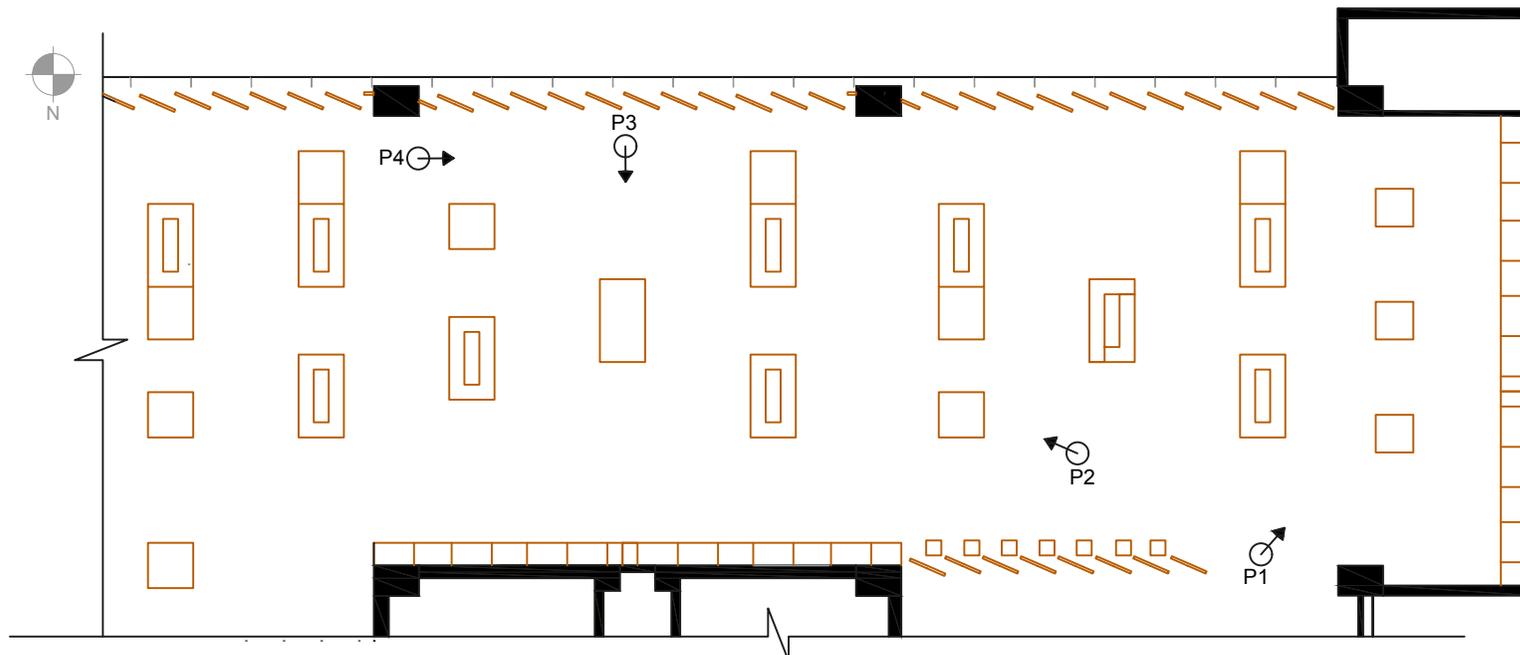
Planta de la ubicación de perspectivas de la nueva propuesta
